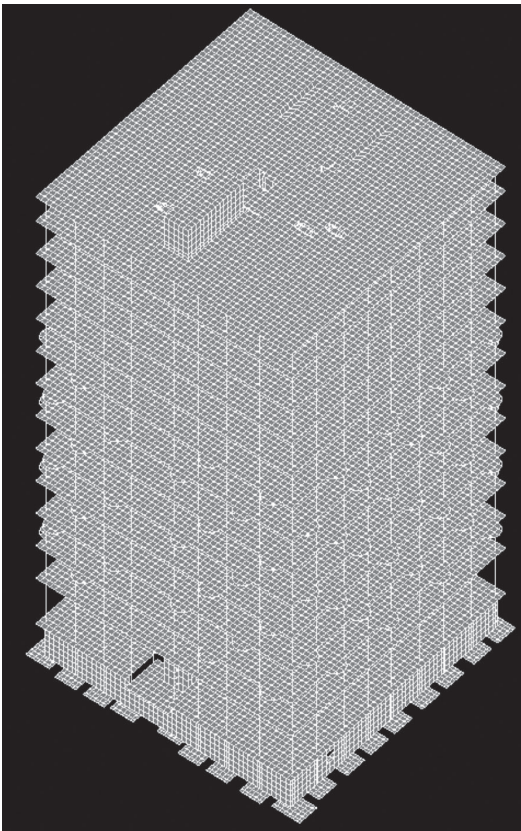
Расчетная схема здания в программе OM СНиП Железобетон
